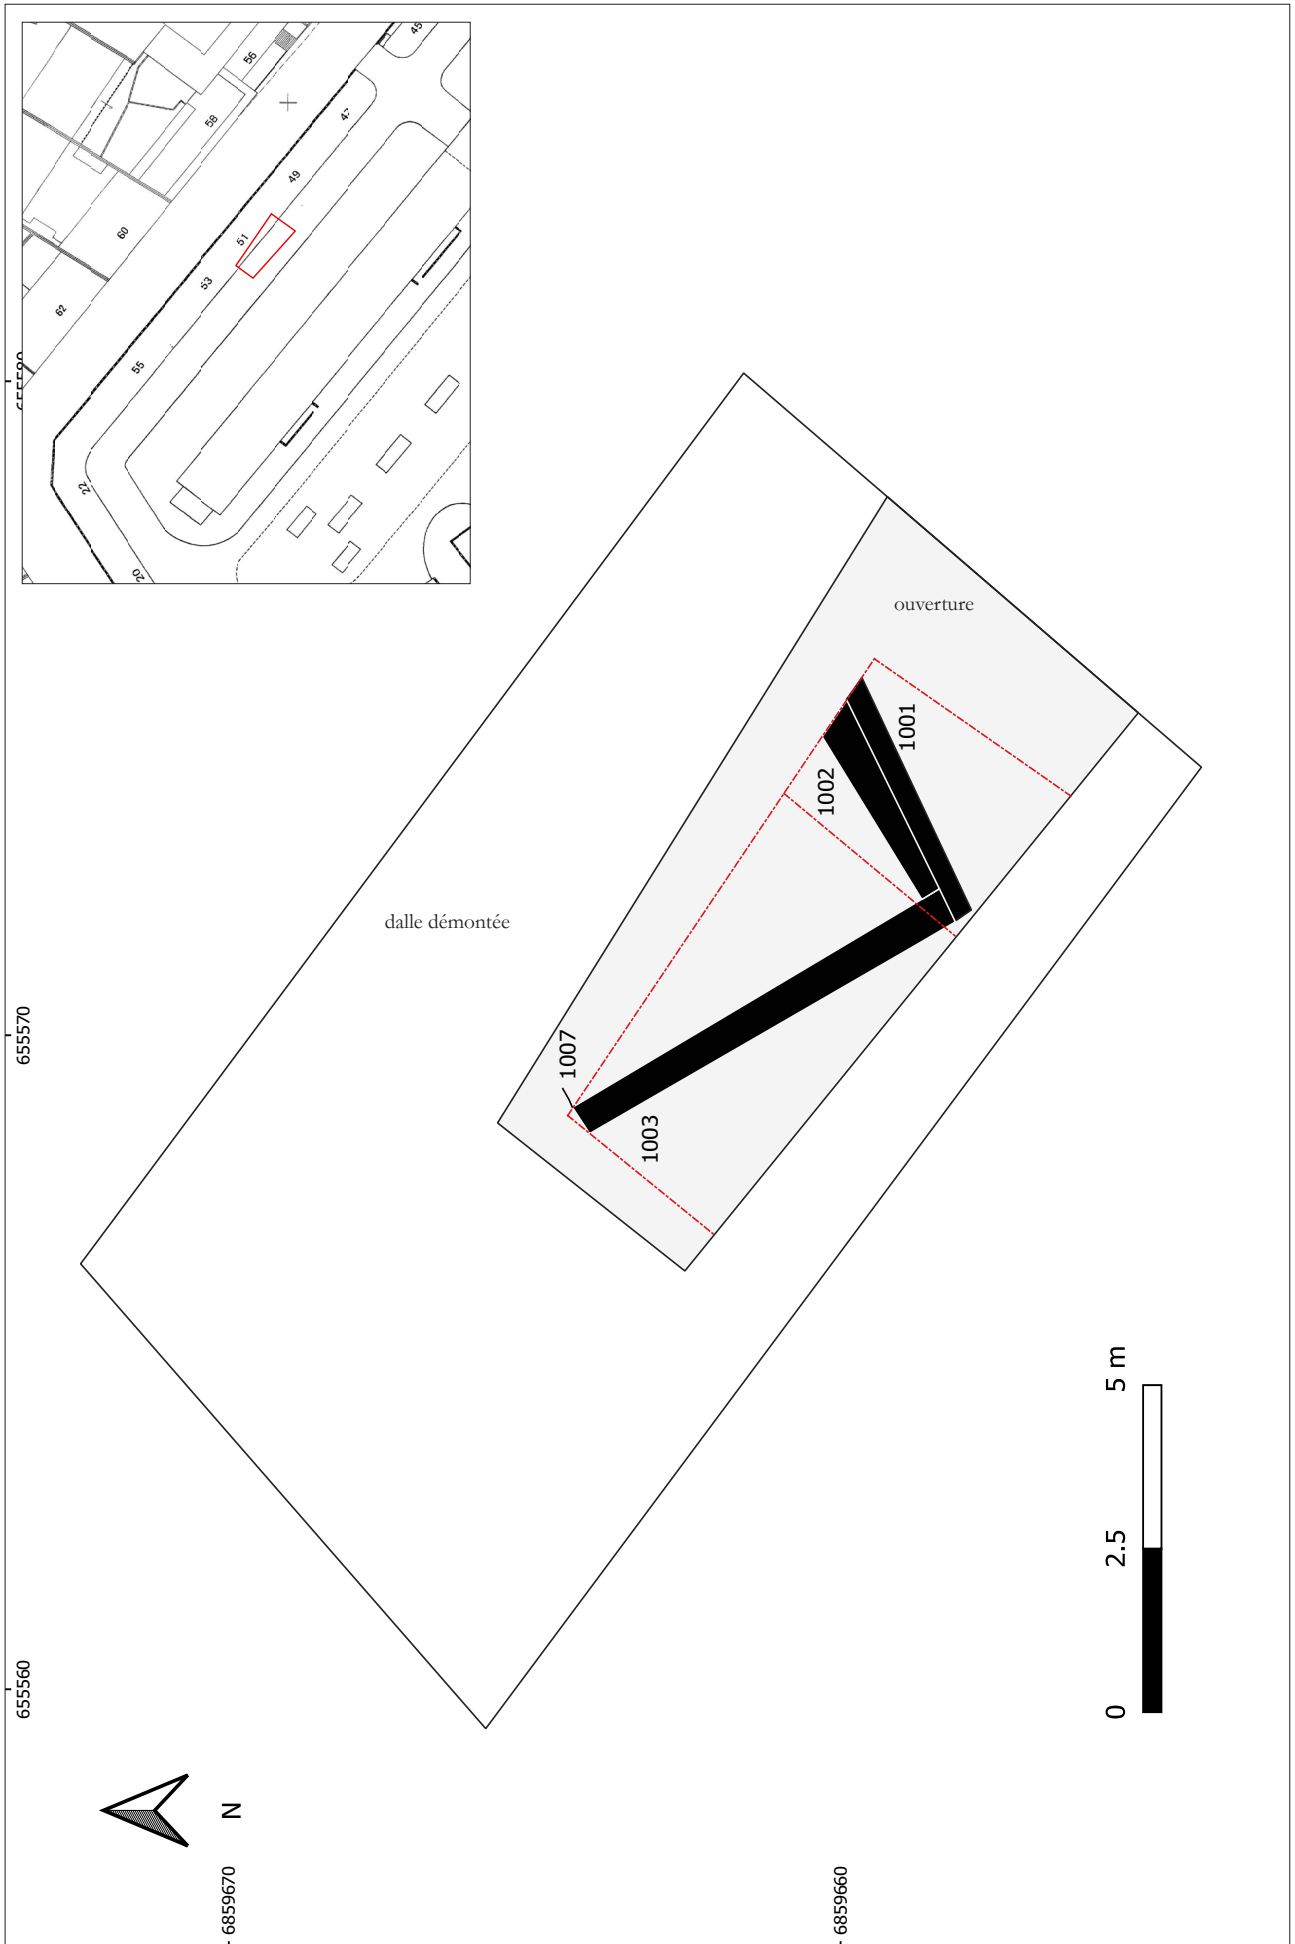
Plan général du diagnostic. Plan, Émilie Cavanna, DHAAP. DAO : David Couturier, DHAAP.
